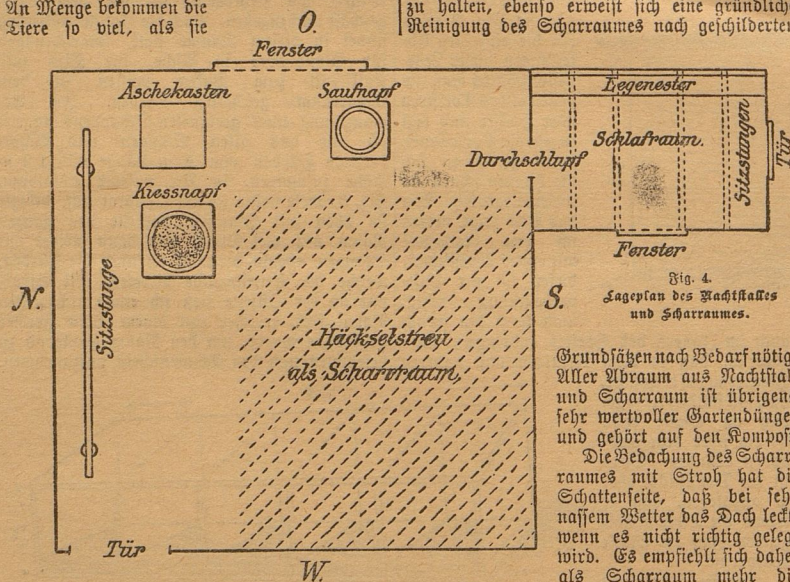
Lageplan des Nachtstalles und Scharraumes.
